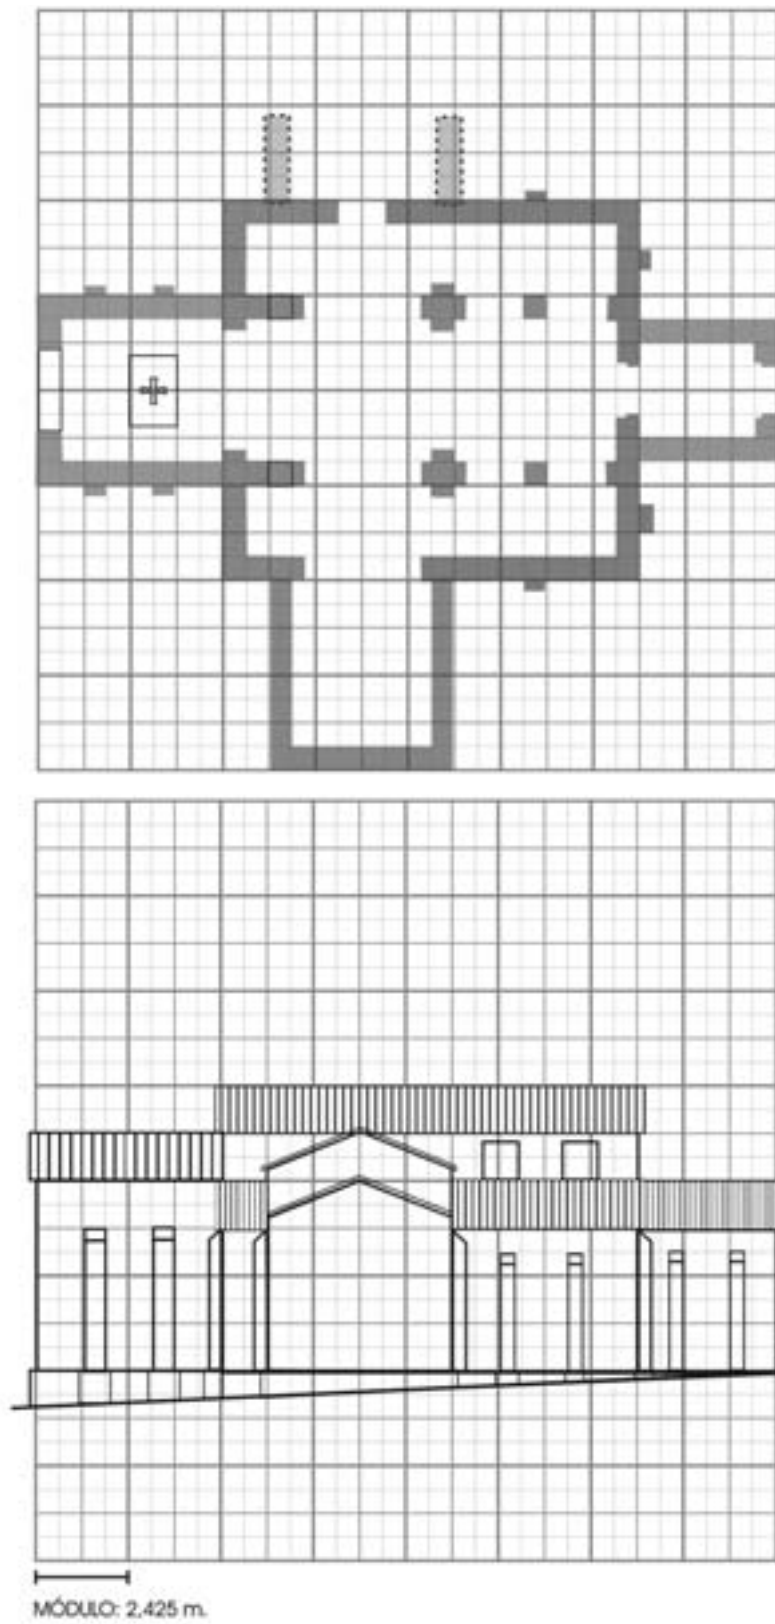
Planta y alzado de la basílica de San Tirso de Oviedo.
